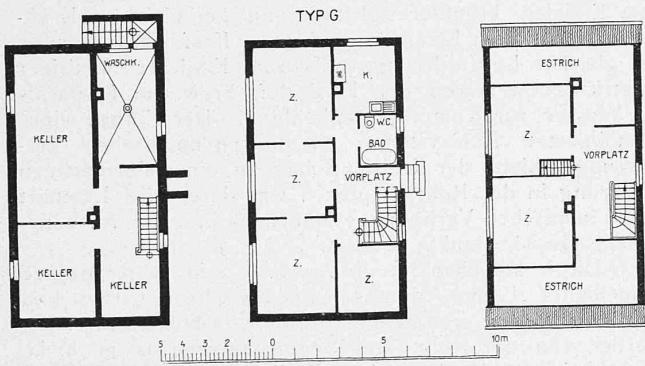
Sechszimmerhaus Typ G. — Masstab aller Grundrisse 1 : 300. — Abb. 10 Dreizimmerhaus Typ C; Abb. 11 Vierzimmerhaus Typ D.
